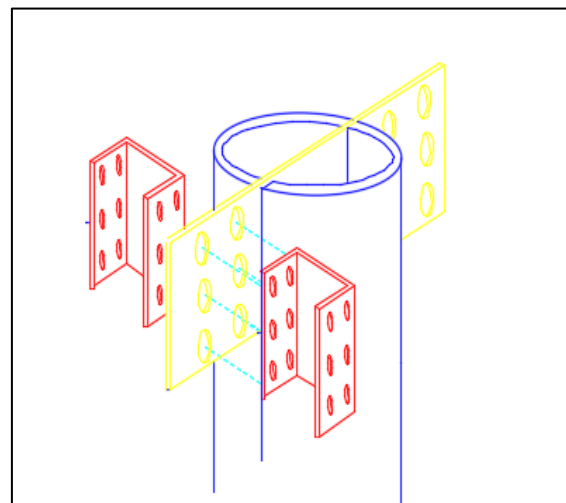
détail de raccordement de poutre et la platine de noyau central Source : auteurs
